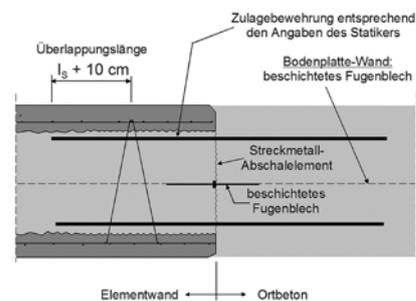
Biegesteifer Anschluss einer Elementwand an eine Ortbetonwand
